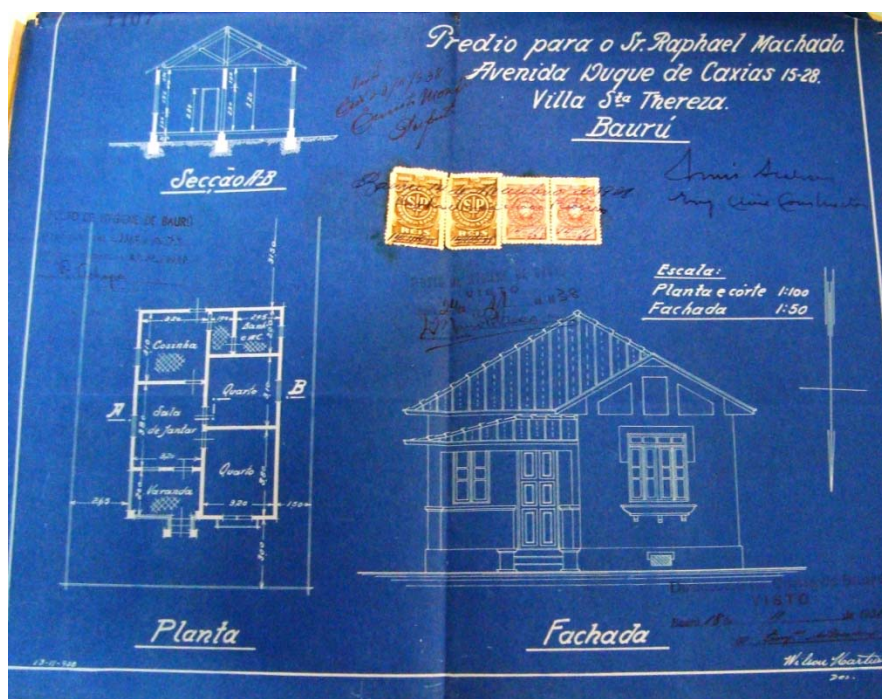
Projeto de bangalô. Fonte: Secretaria do planejamento de Bauru (SEPLAN), 2014.
